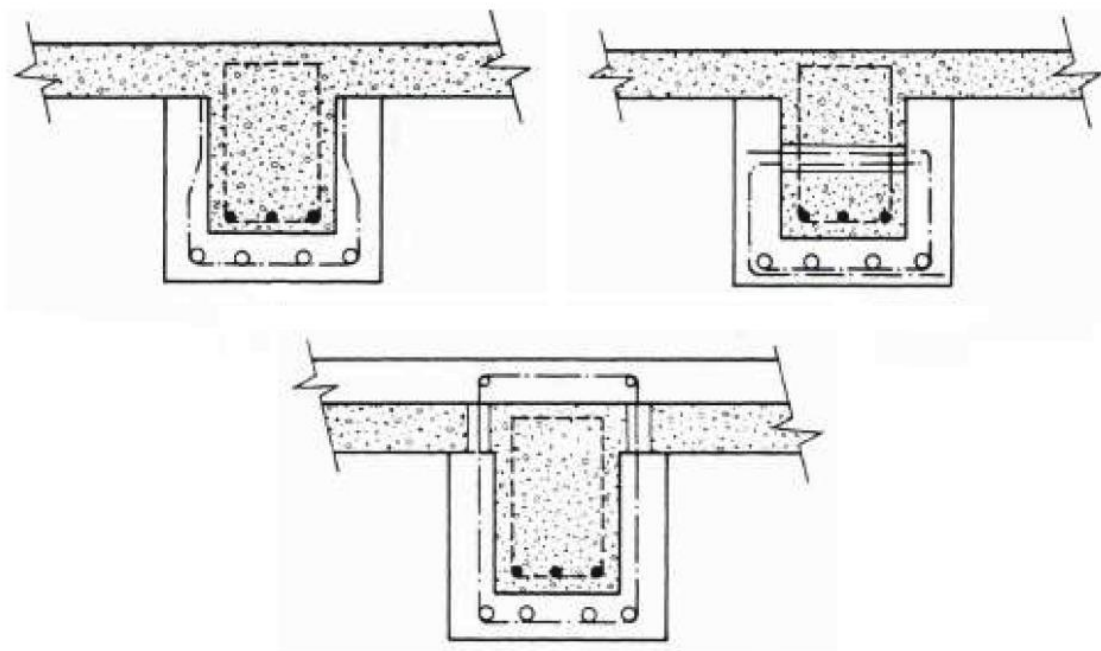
Configurações de aumento da seção transversal e adição de armaduras transversais e longitudinais.
